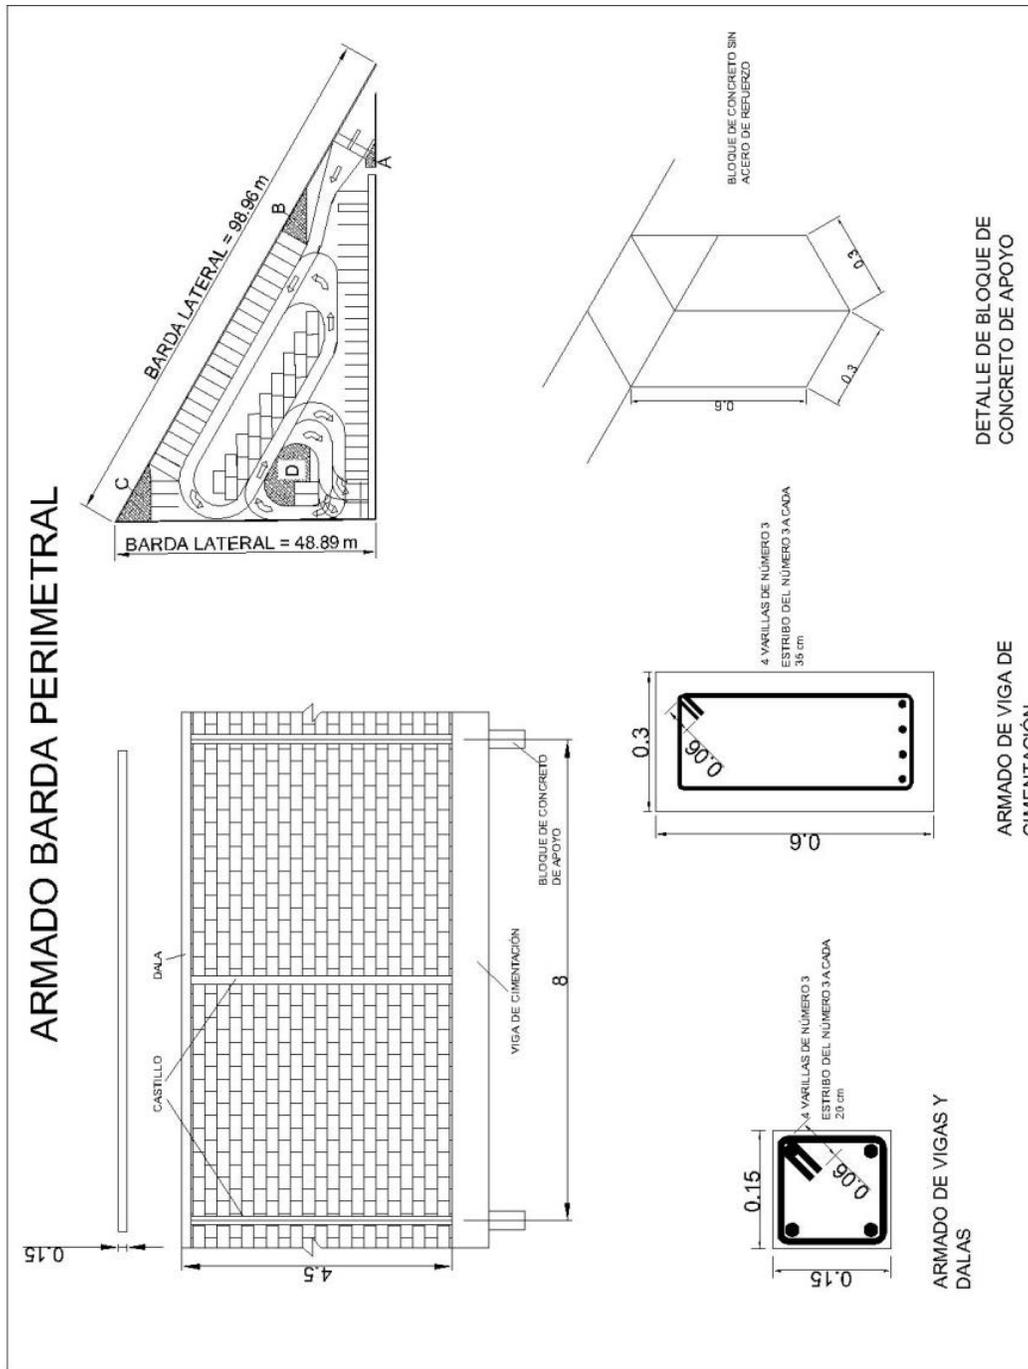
Plano de armado de barda perimetral (fuente: dibujo hecho por el autor).
